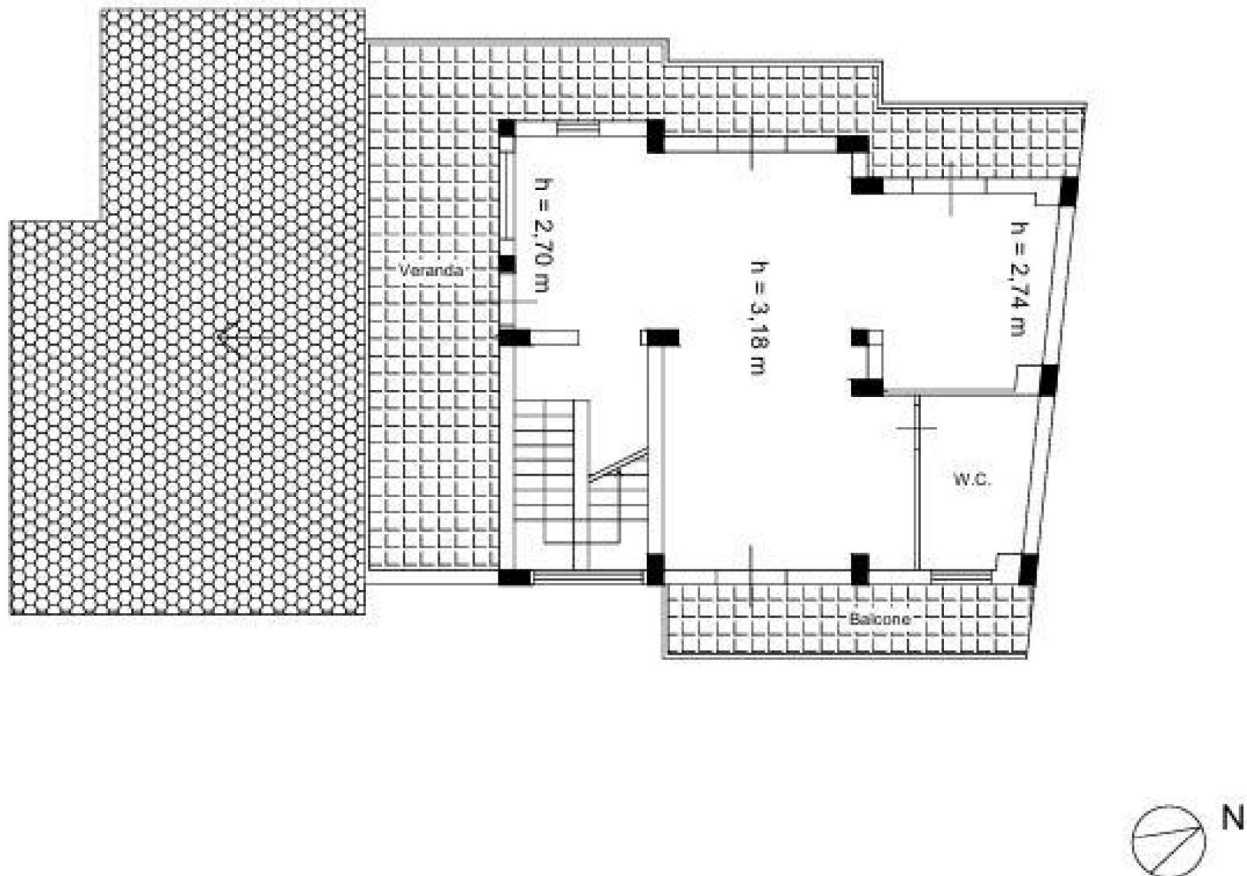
Piano Piano 2° Stato reale dei luoghi
